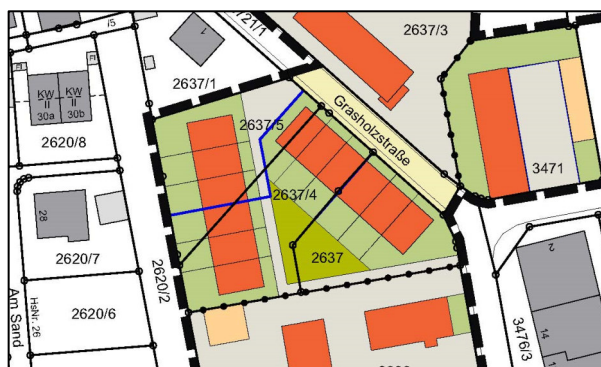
Bebauung mit Reihenhäusern auf Gemeinschaftsgrund; bis zu 12, max. 14 Reihenhäuser möglich (je nach Gebäudebreite)
